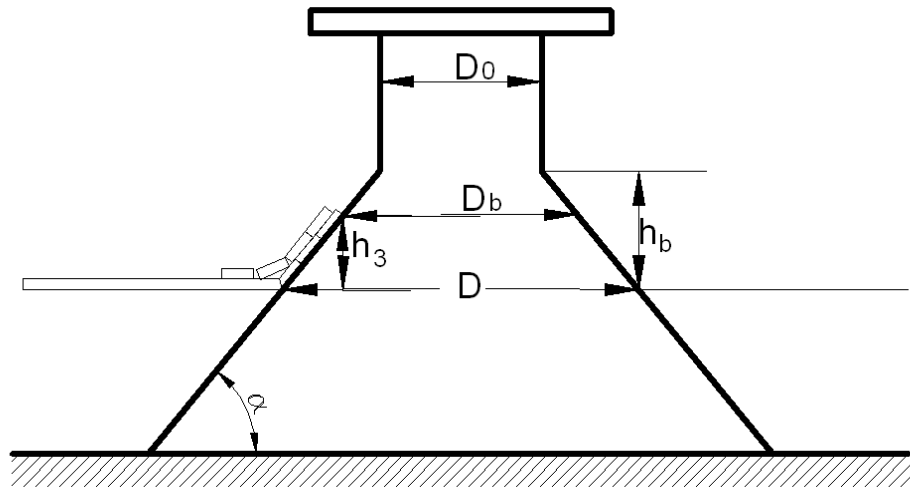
Платформа з розширюваними вниз конічними бортами
